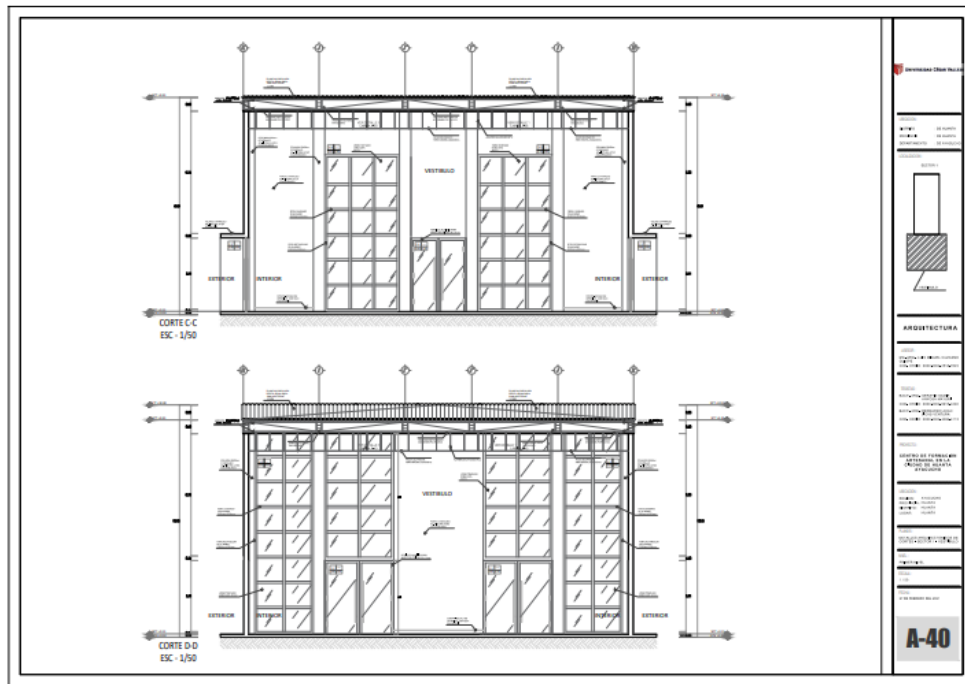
Detalles arquitectónicos por sectores escala 1/50.
